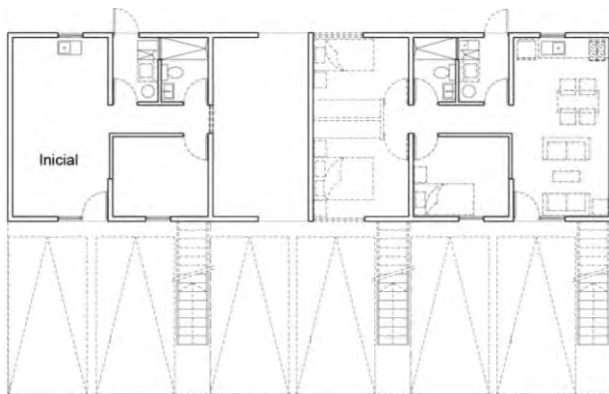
Casa inicial en planta baja con *slack space*. Viviendas Las Anacuas, 2008-2010
